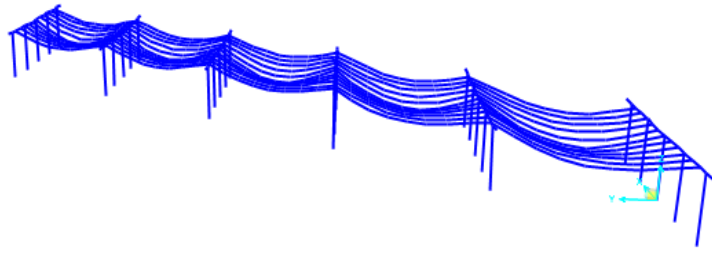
Imagen del modelo donde se evidencia el comportamiento de las vigas Longitudinales. (SAP2000).
